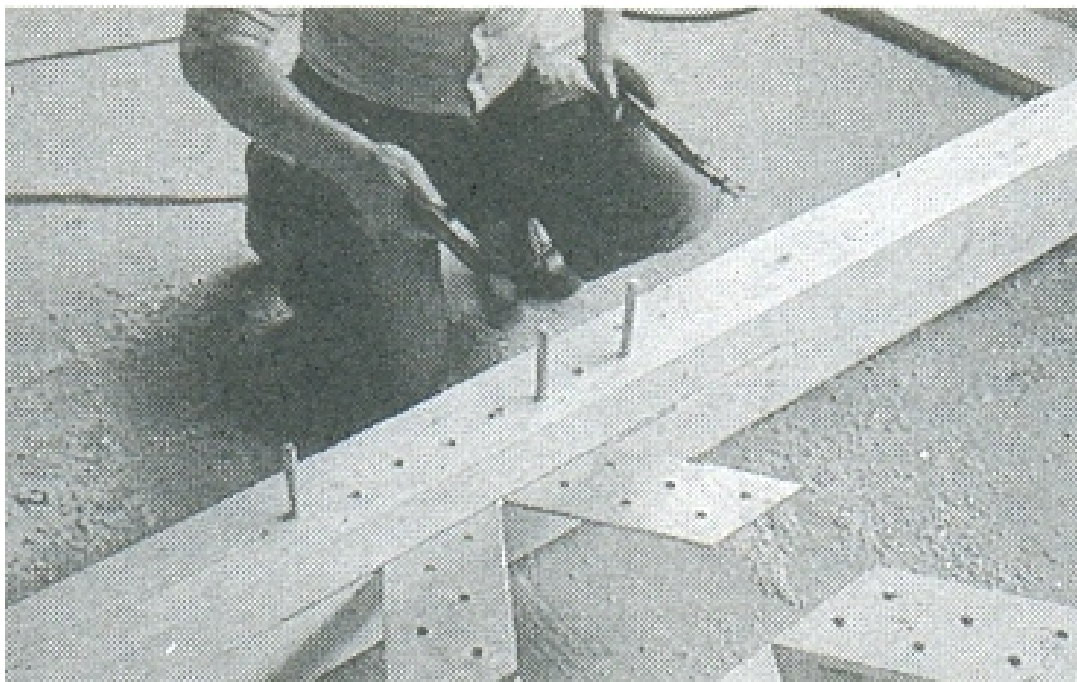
Fabricação de vigamento (triangular) em marcenaria, chapas metálicas e cavilhas
